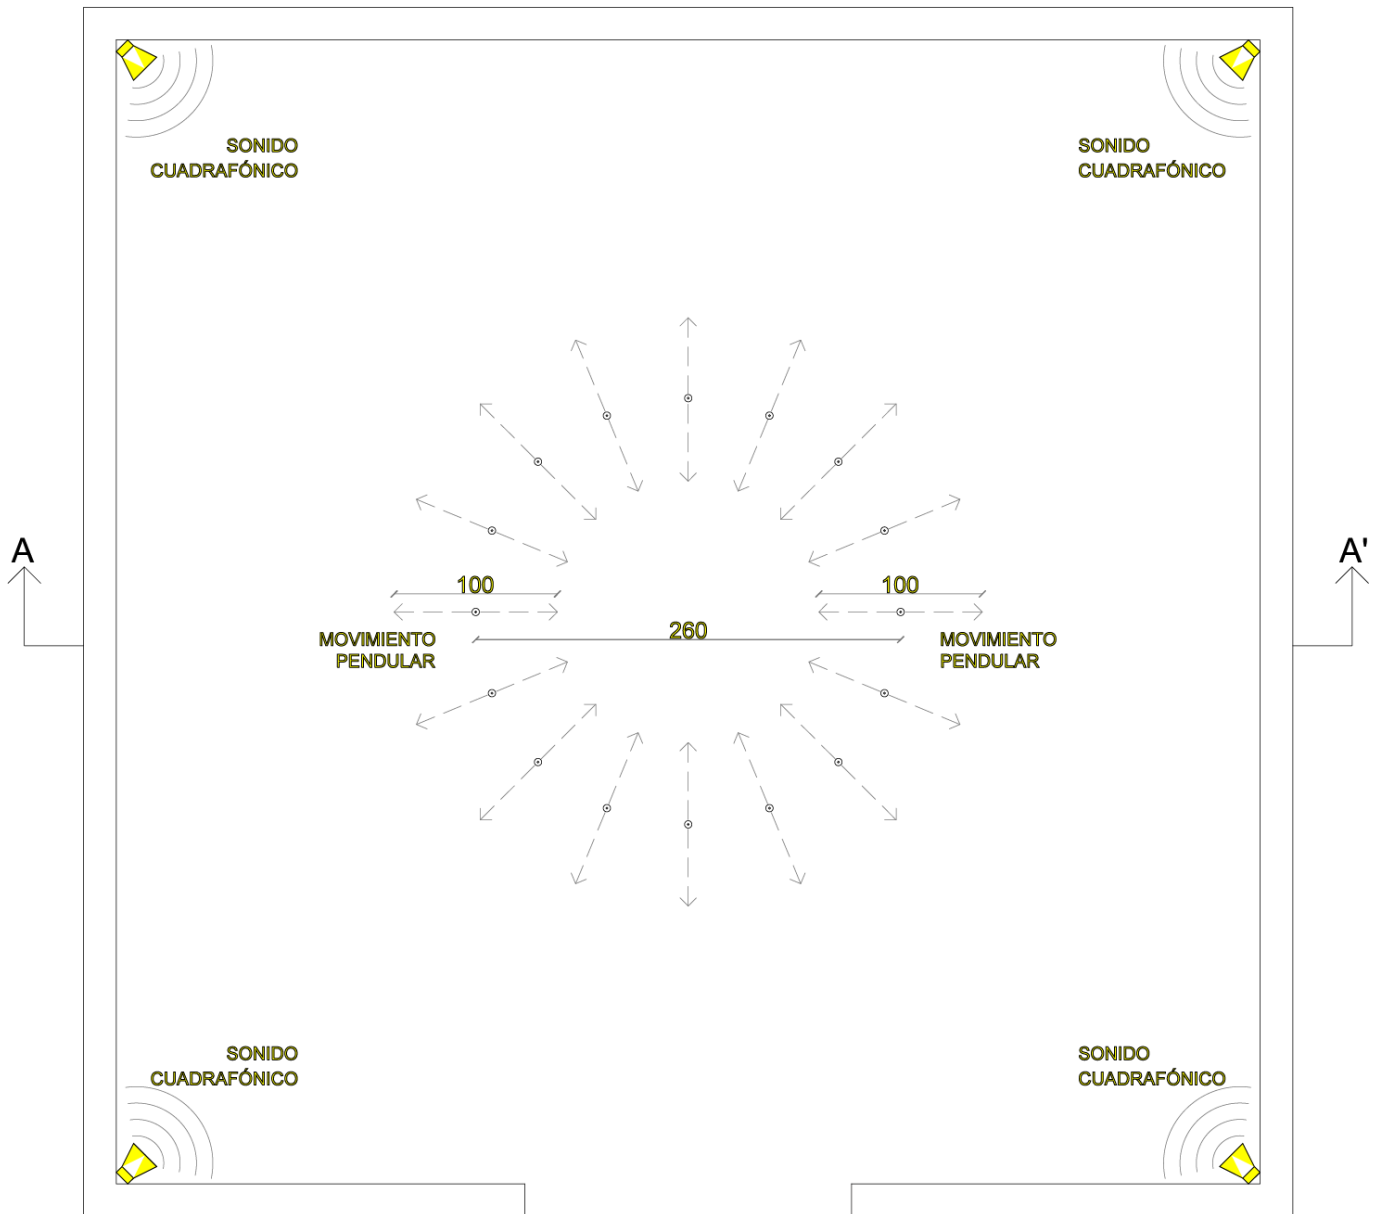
Constanza Ipinza, Planta de instalación, Captura de imagen Autocad, 2015.
